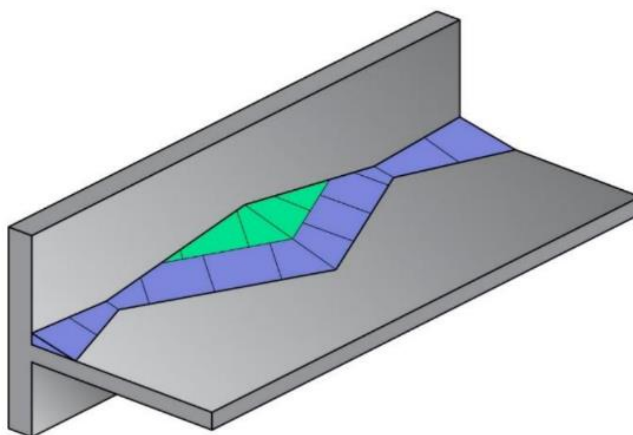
Схема укладки уклонообразующего слоя в парапетной зоне.
